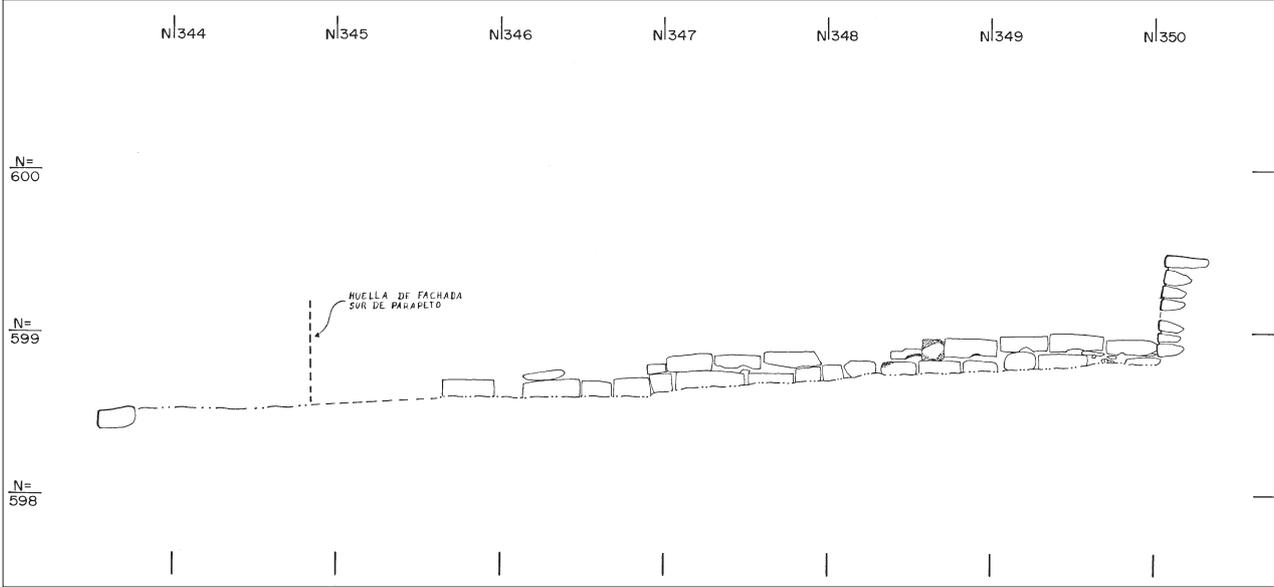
Fachada con vista al Oeste de el parapeto que une a estructura 9L-100 y 103
